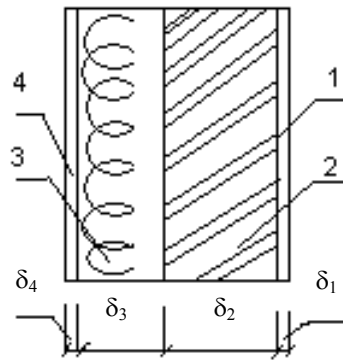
К примеру определения толщины утепляющего слоя наружной стены
